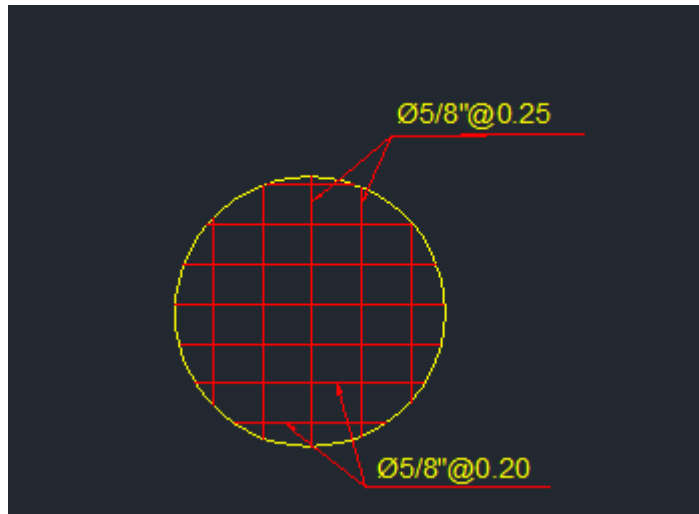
Detalle de barras corrugadas forma de malla de 5/8”
